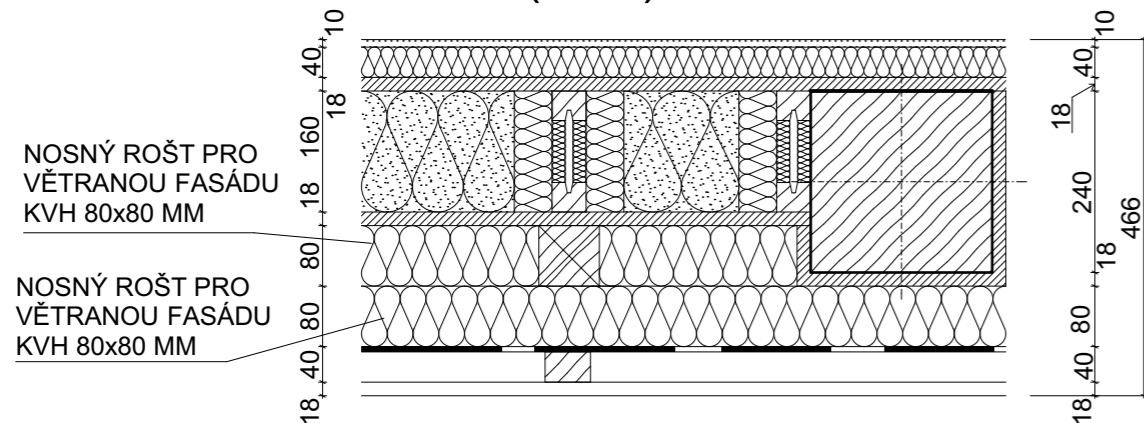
# DETAIL - OBVODOVÝ PLÁŠŤ (1:10)
